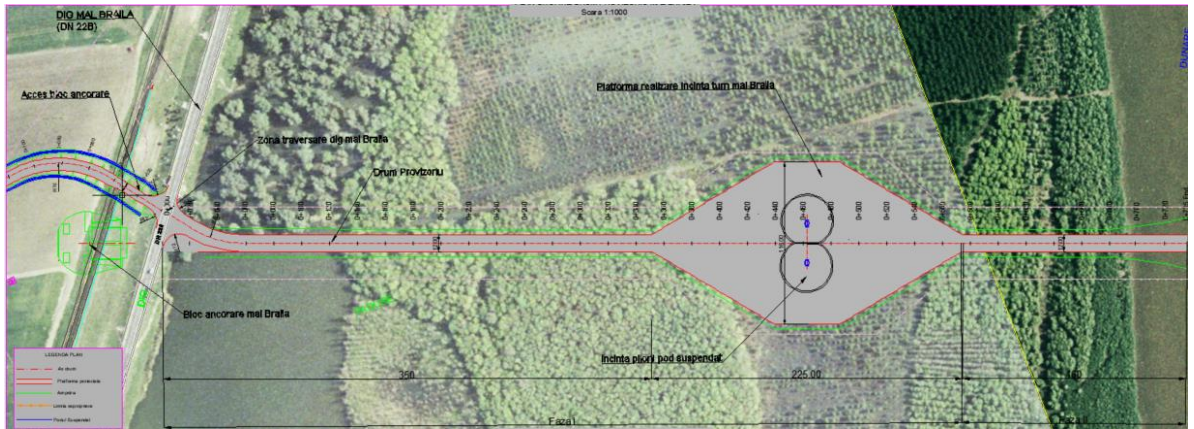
Plan situație - drum provizoriu mal Brăila
